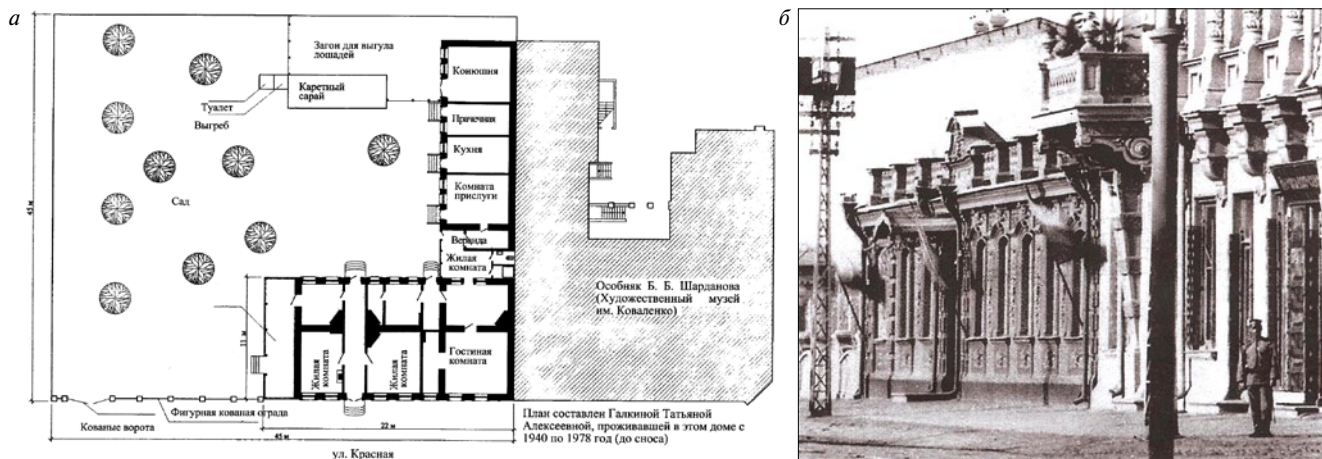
Особняк Н.Д. Маламы: а – схематический план; б – первоначальный вид фасада особняка, примыкающего к фасаду особняка Б.-Б. Шарданова
